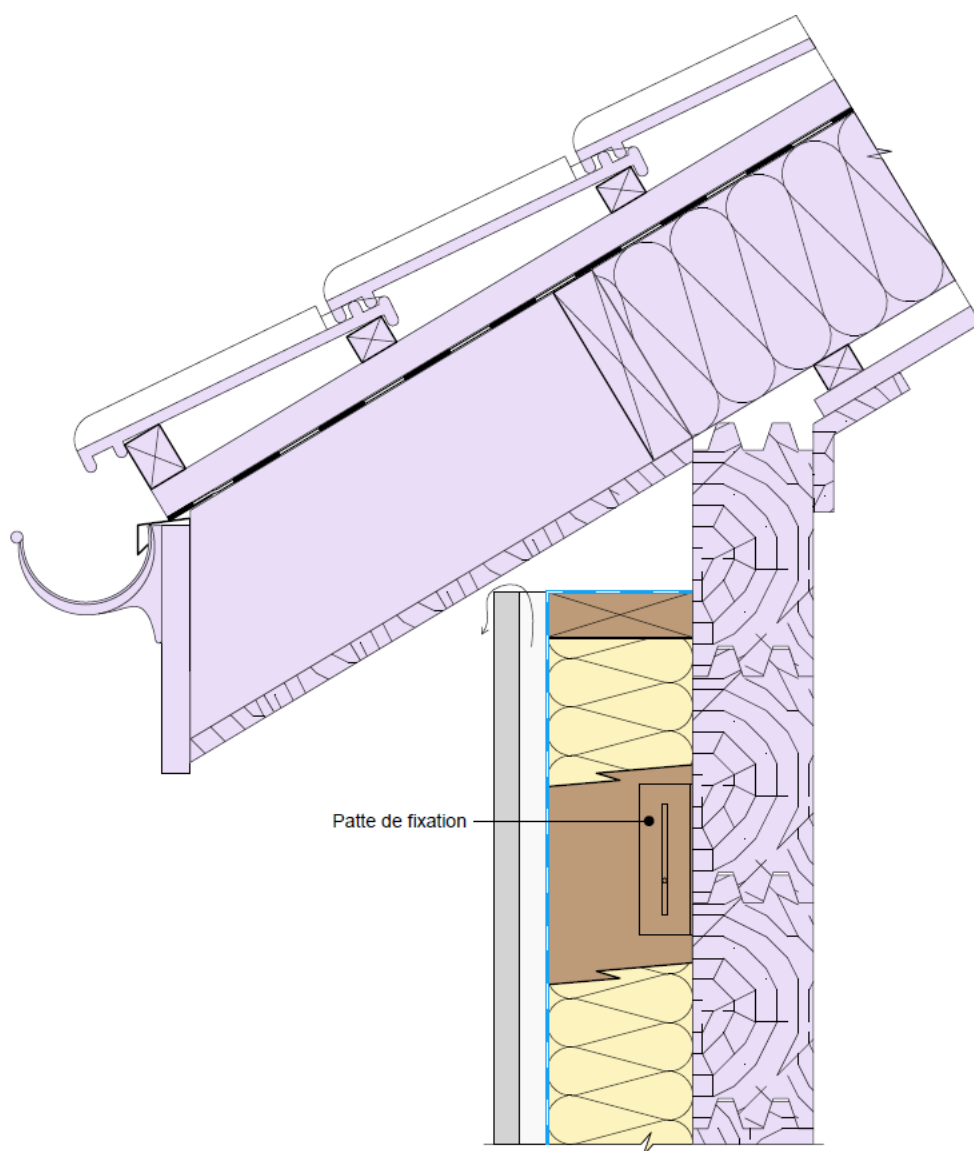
Raccordement sous débord de toiture (coupe verticale)
